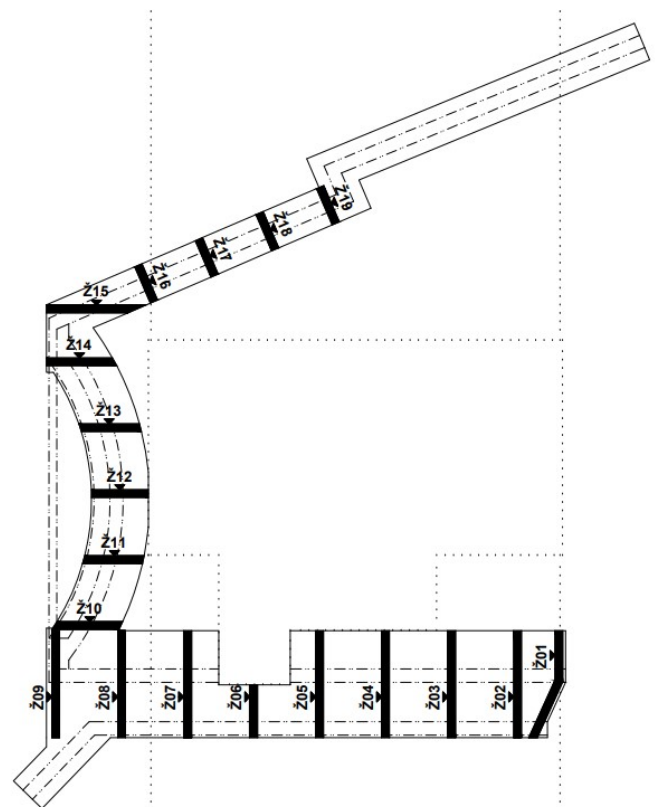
pojmenování systémů konstrukcí 1.NP
